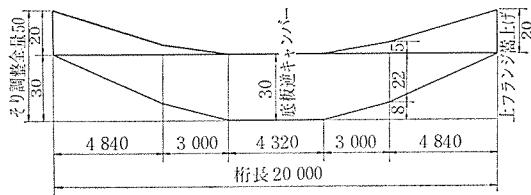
底板逆キャンバーおよび上フランジ嵩上げ図
